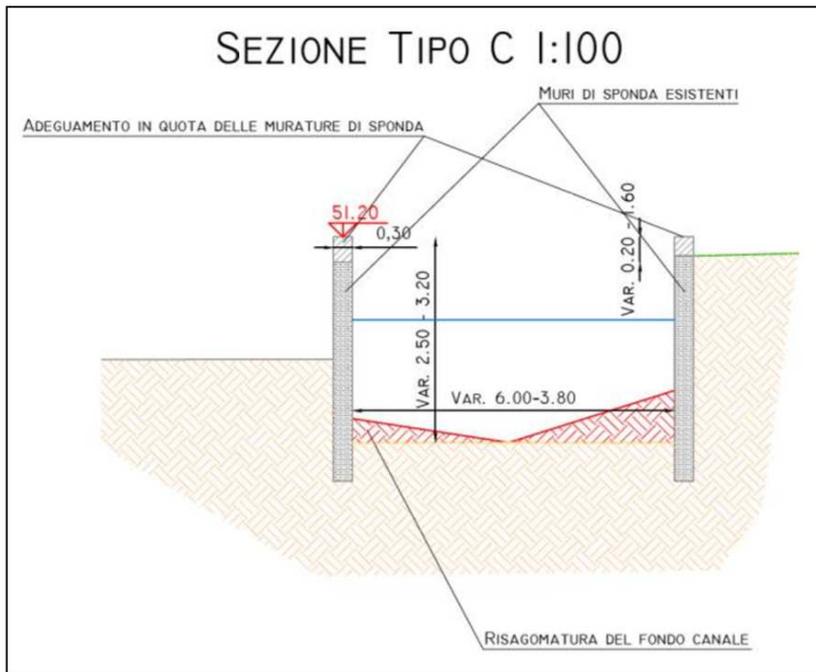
Sezione tipologica di intervento a valle dell'attraversamento al vialetto di accesso privato.
